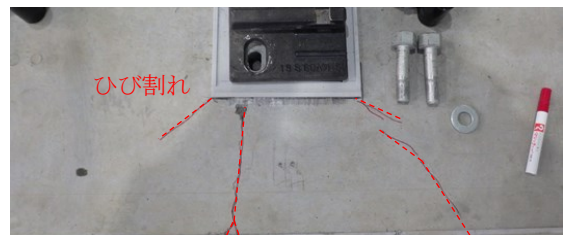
スラブ軌道表面に発生したひび割れの状況
